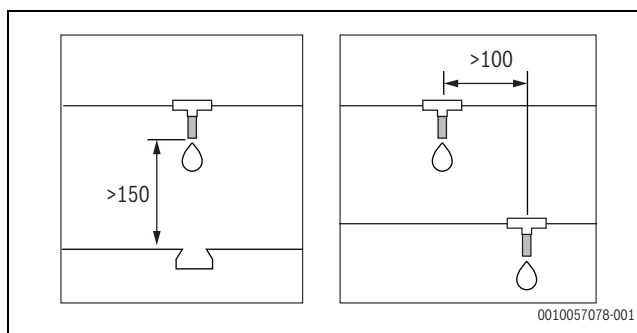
Distanze di installazione della valvola antigelo in millimetri (mm)
